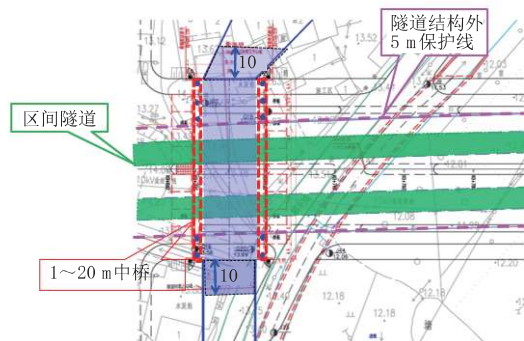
规划北纵二河中桥平面与地铁位置关系图(单位:m)
